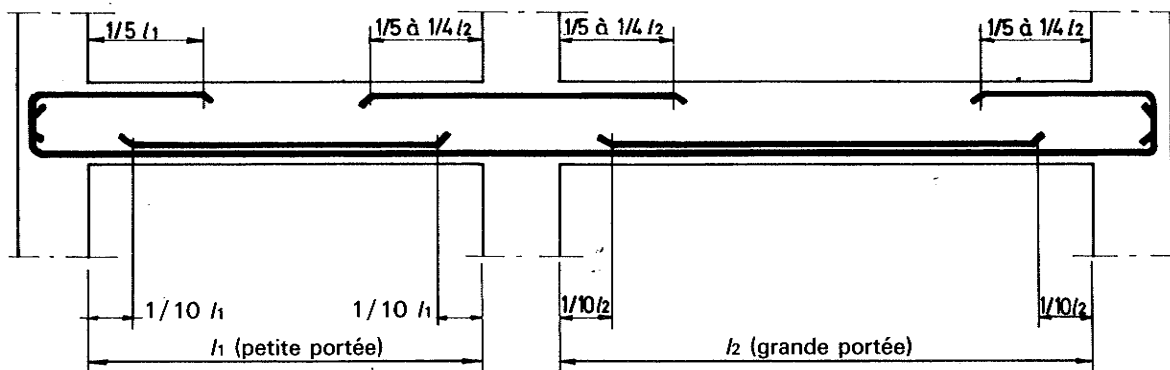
Règles pratiques pour l'arrêt des chapeaux et des aciers situés à la partie inférieure de la poutre.
